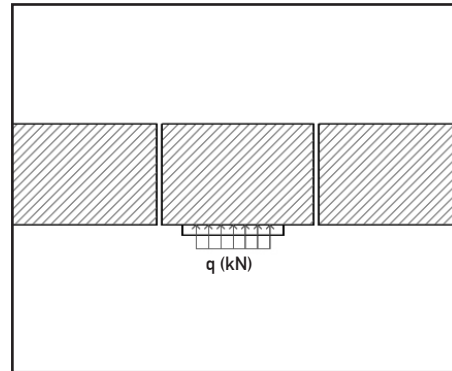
Detalle discontinuidad mecánica muro-medallón como origen de incremento de la fisuración.
